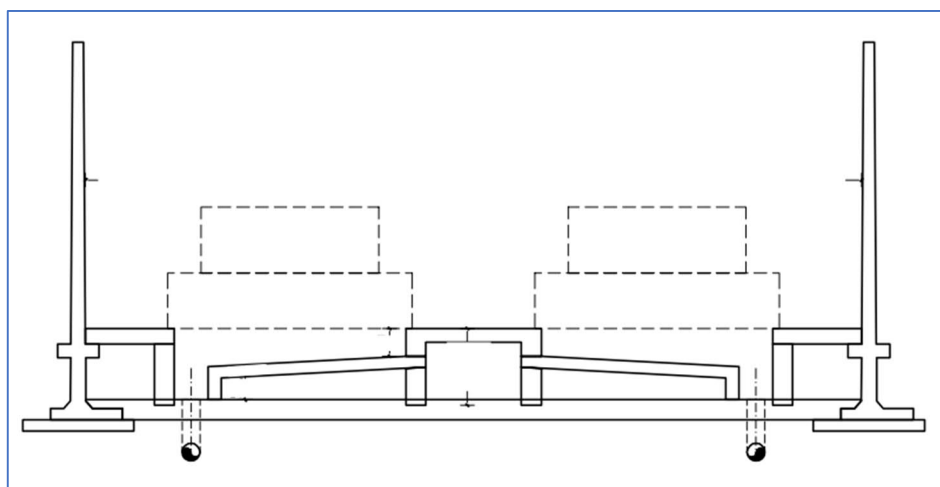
Sezione tipo di sala parto con pavimento a pareti inclinate
